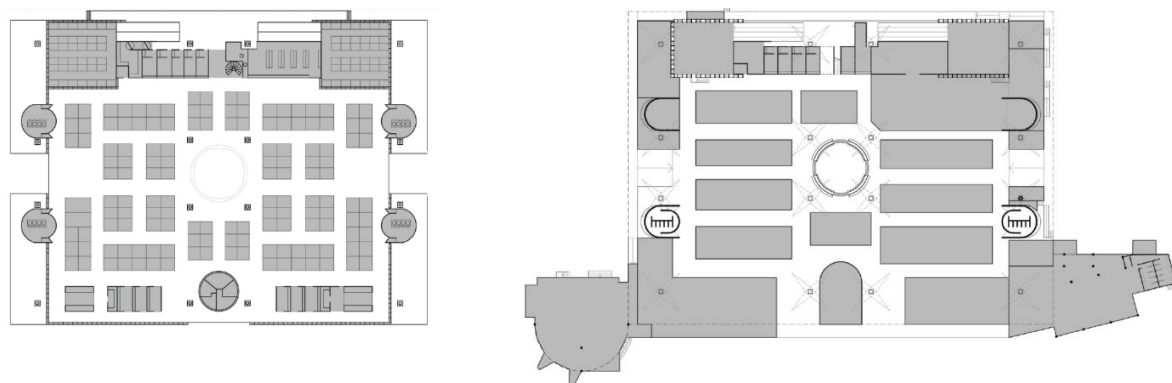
Planta Original (projeto Éolo Maia) X Planta Atual (levantamento)
